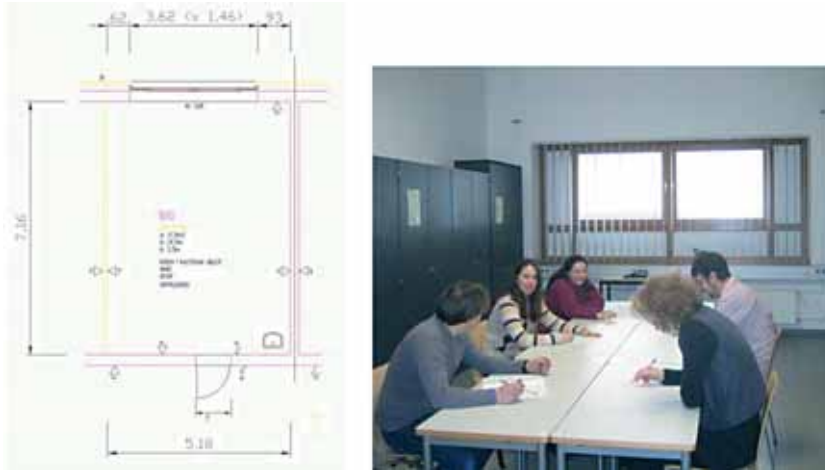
Grundriss und Foto des Testraums mit Testpersonen und Versuchsleiterin
